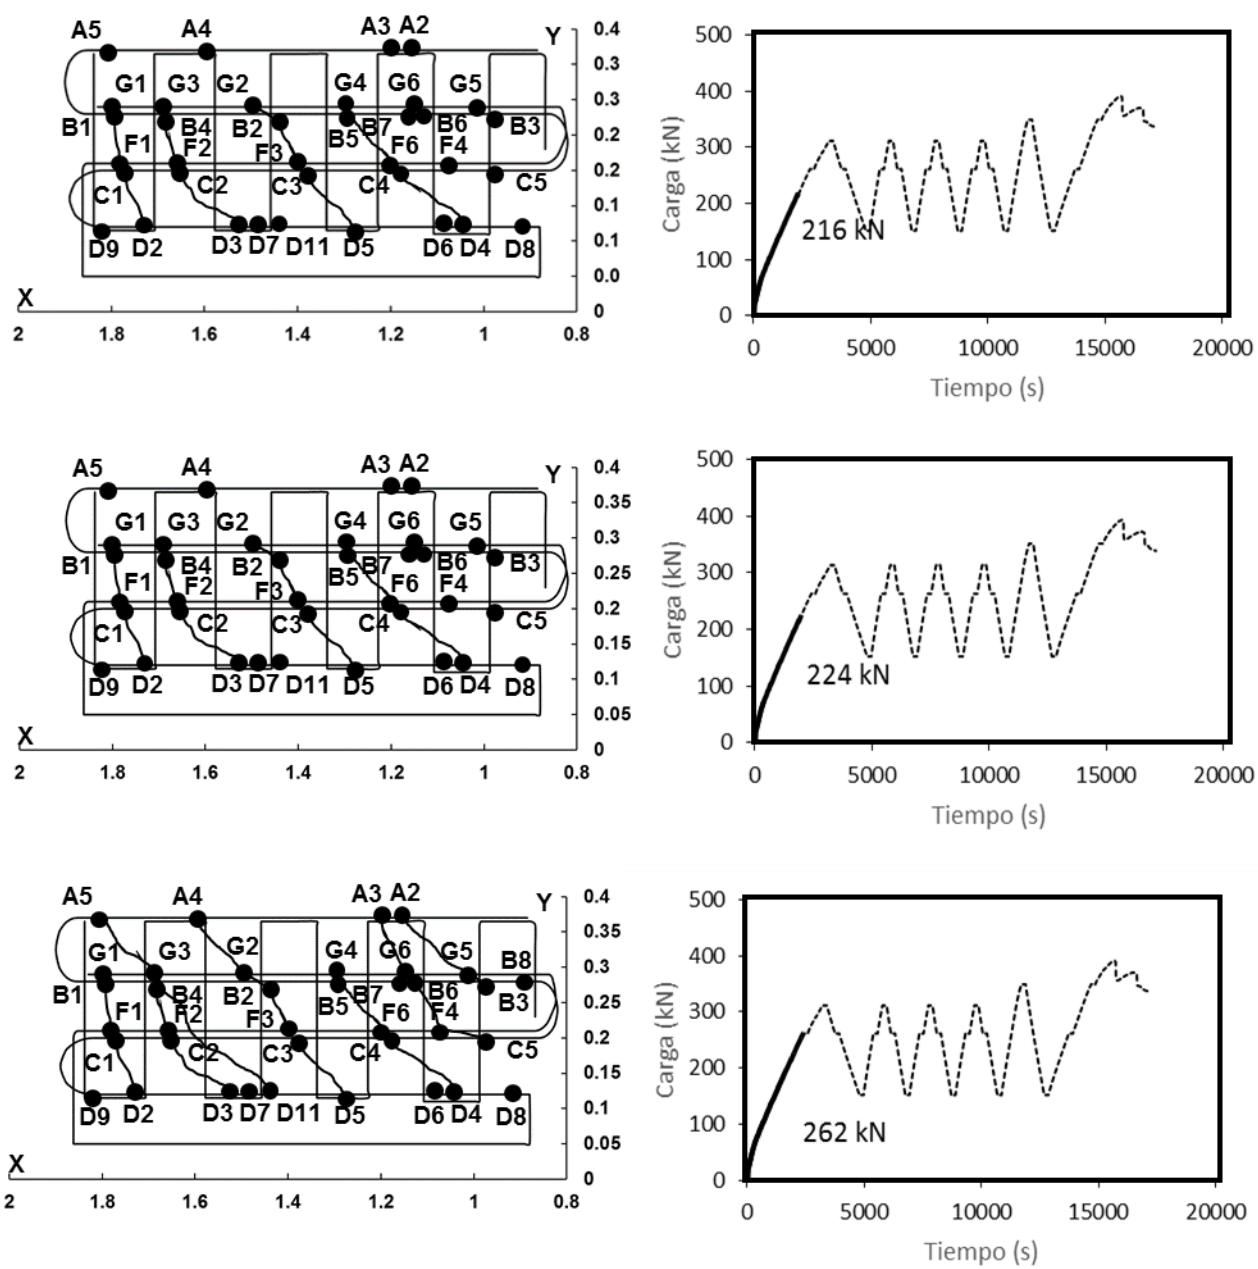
Patrones de fisuración de la viga I-1 (216 a 262 kN)
